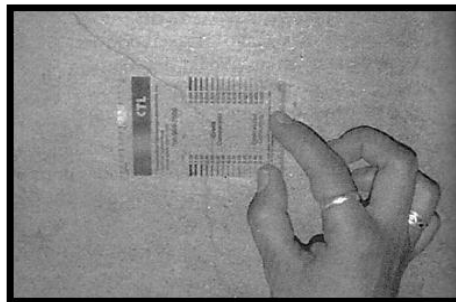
Medida del ancho del ancho de fisuras, mediante un comparador de fisuras. Nota: tomado de Sánchez Diego (2003).
